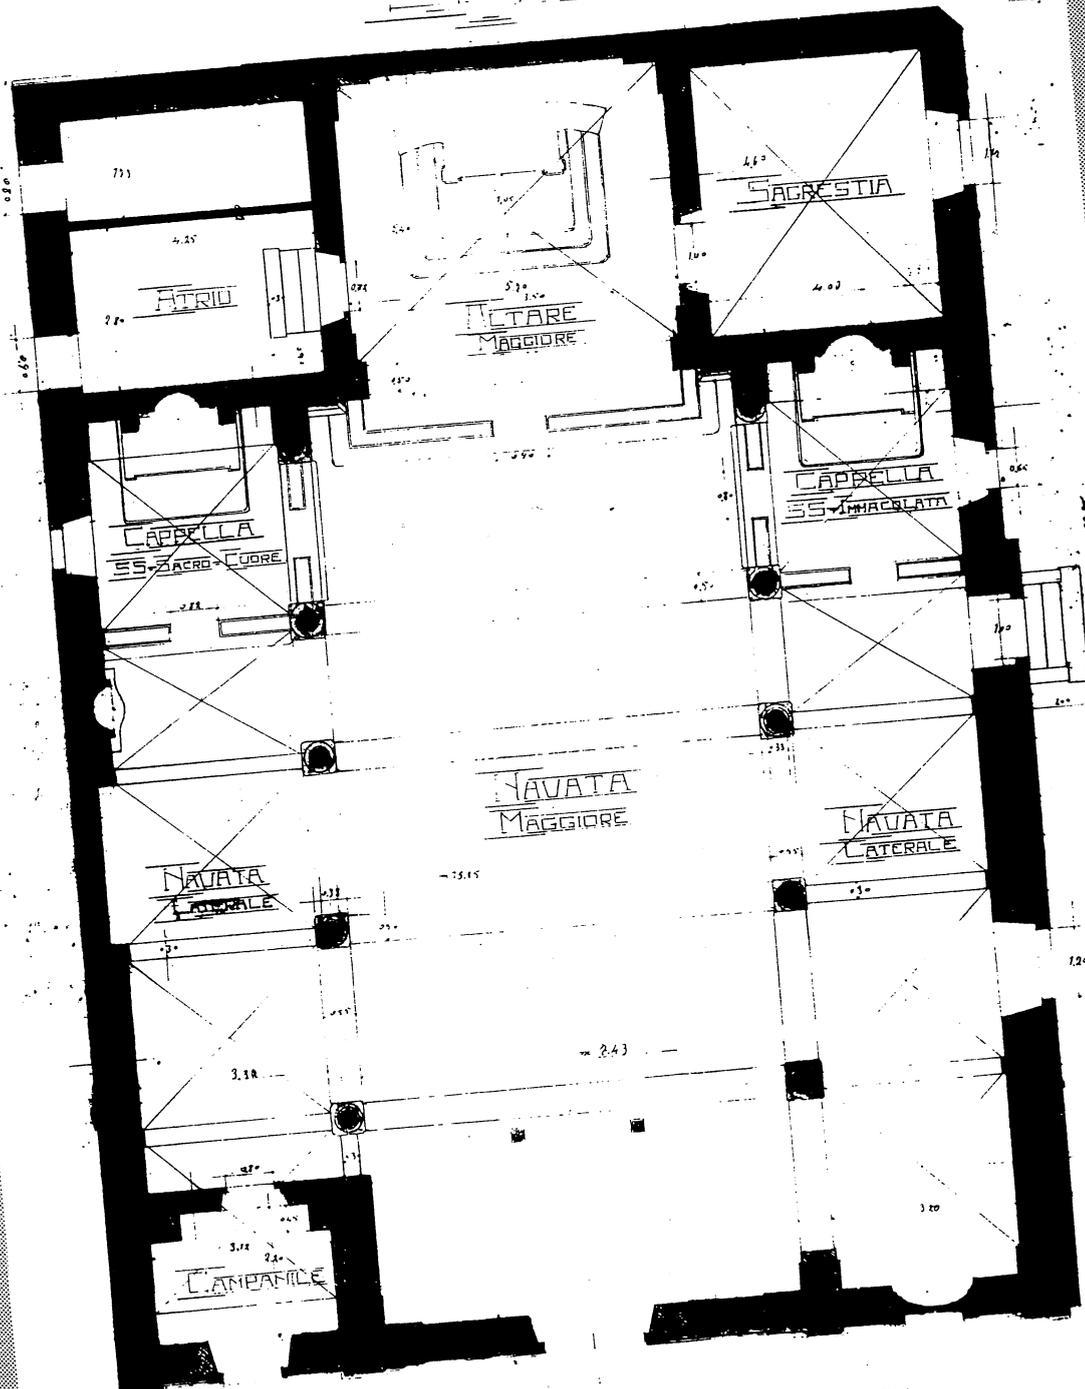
Planimetria della Chiesa Parrocchiale di Lavena nel 1931
